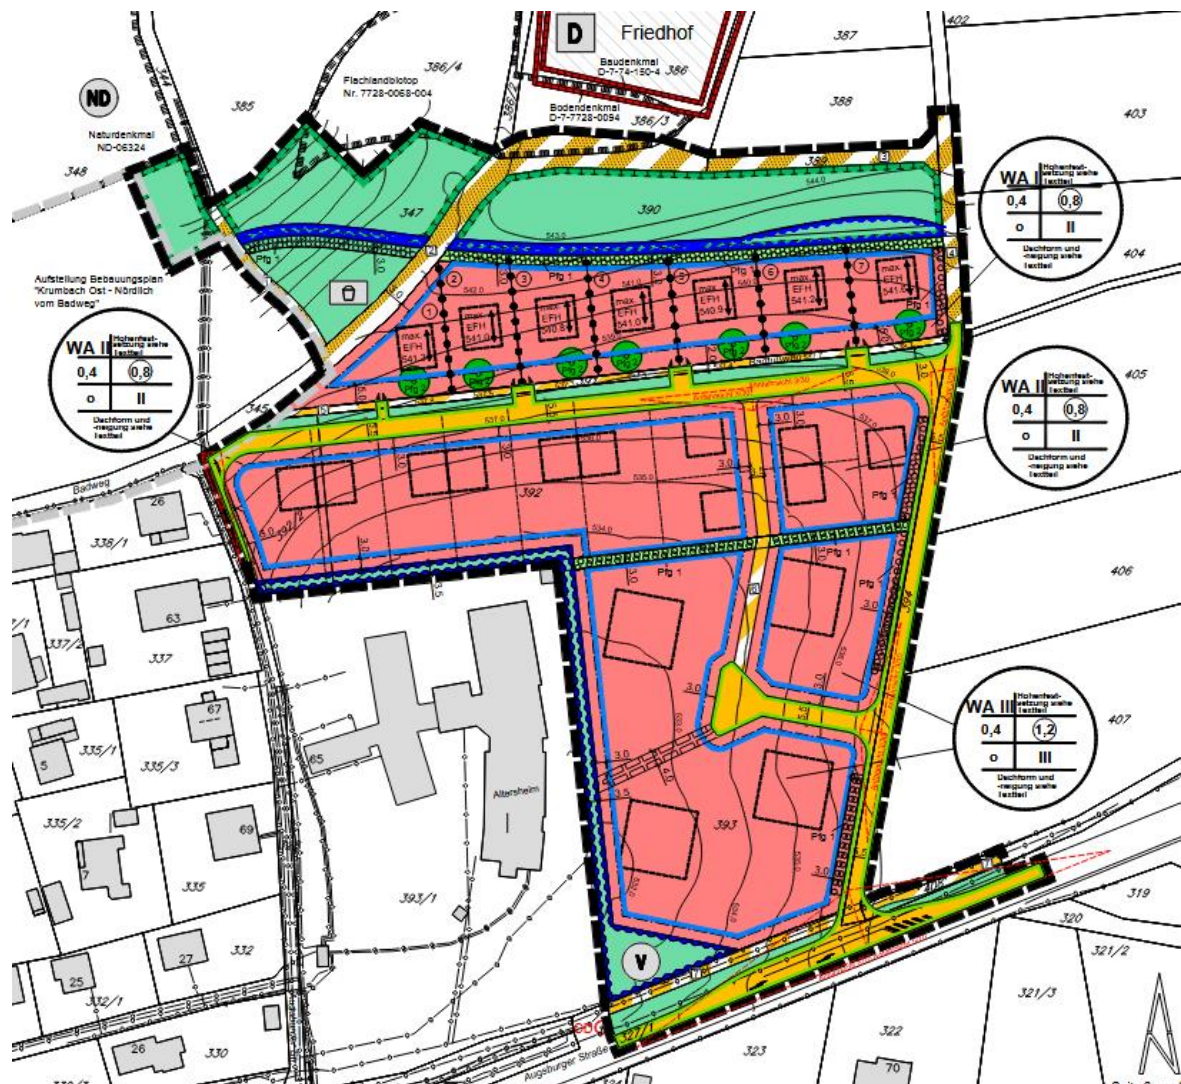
Lageplan Bauvorhaben (Gansloser, 2024)
